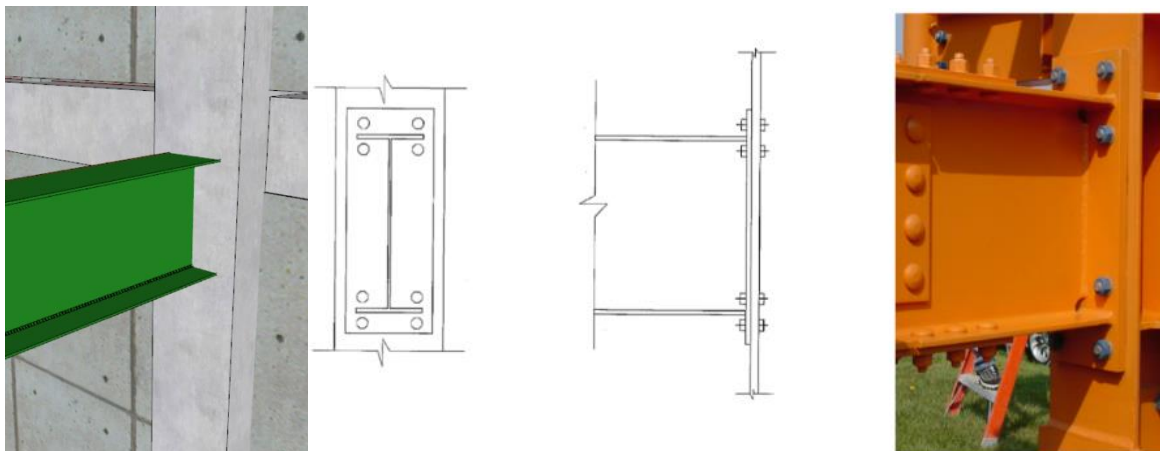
Viga verde: 0.55 m. de peralte. Conexión Viga-Columna(concreto): Placas de extremo. Fuente: Elaboración propia
